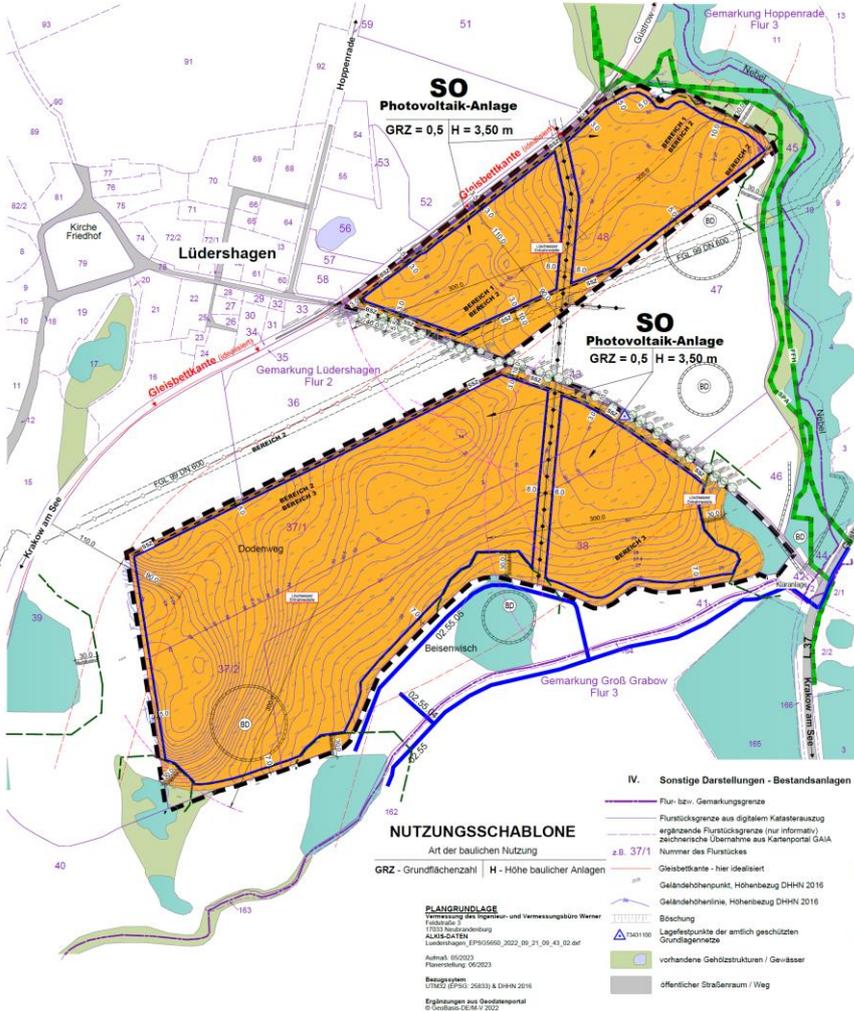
Planflächen des B-Plan Nr. 5 südöstlich von Lüdershagen. Quelle: Begründung B-Plan Nr. 5.
